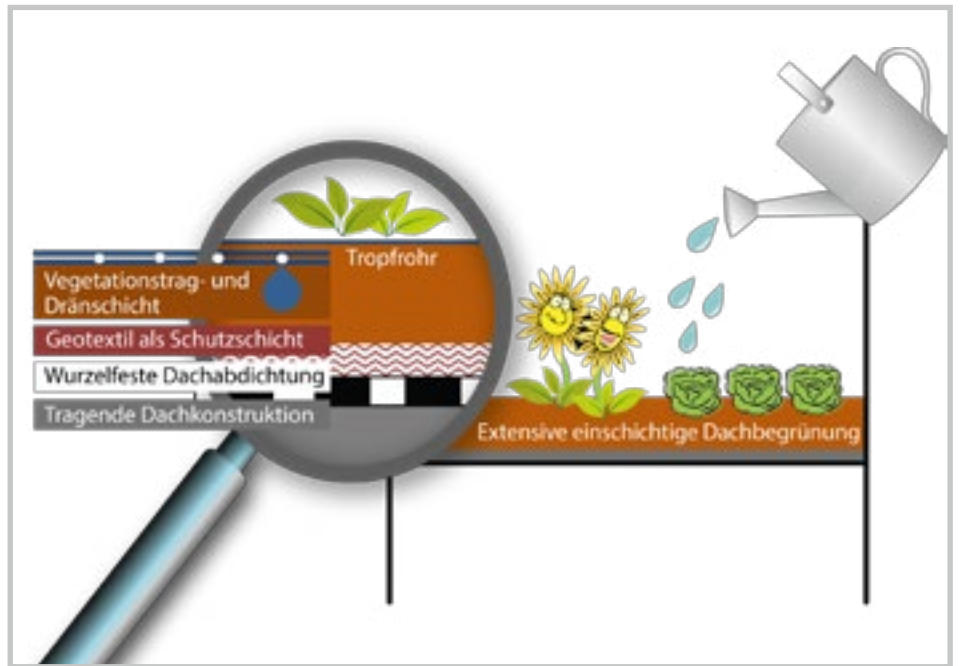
Aufbau des Gemüsedaches: Aus einer einfachen Extensivbegrünung wird ein „essbares“ Dach
